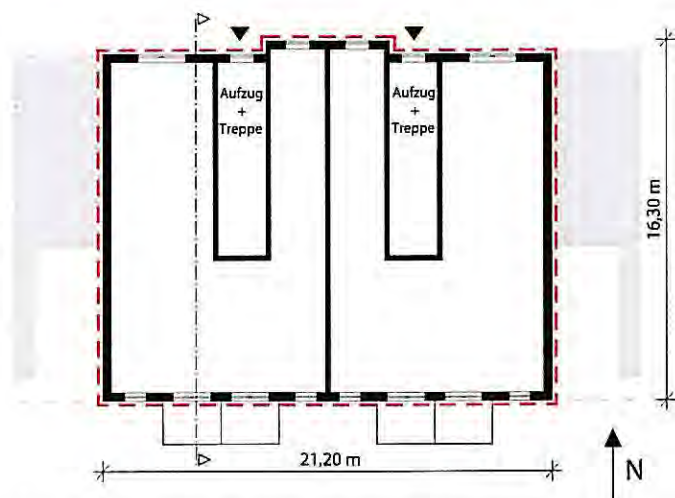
Grundriss des betrachteten Gebäudes
